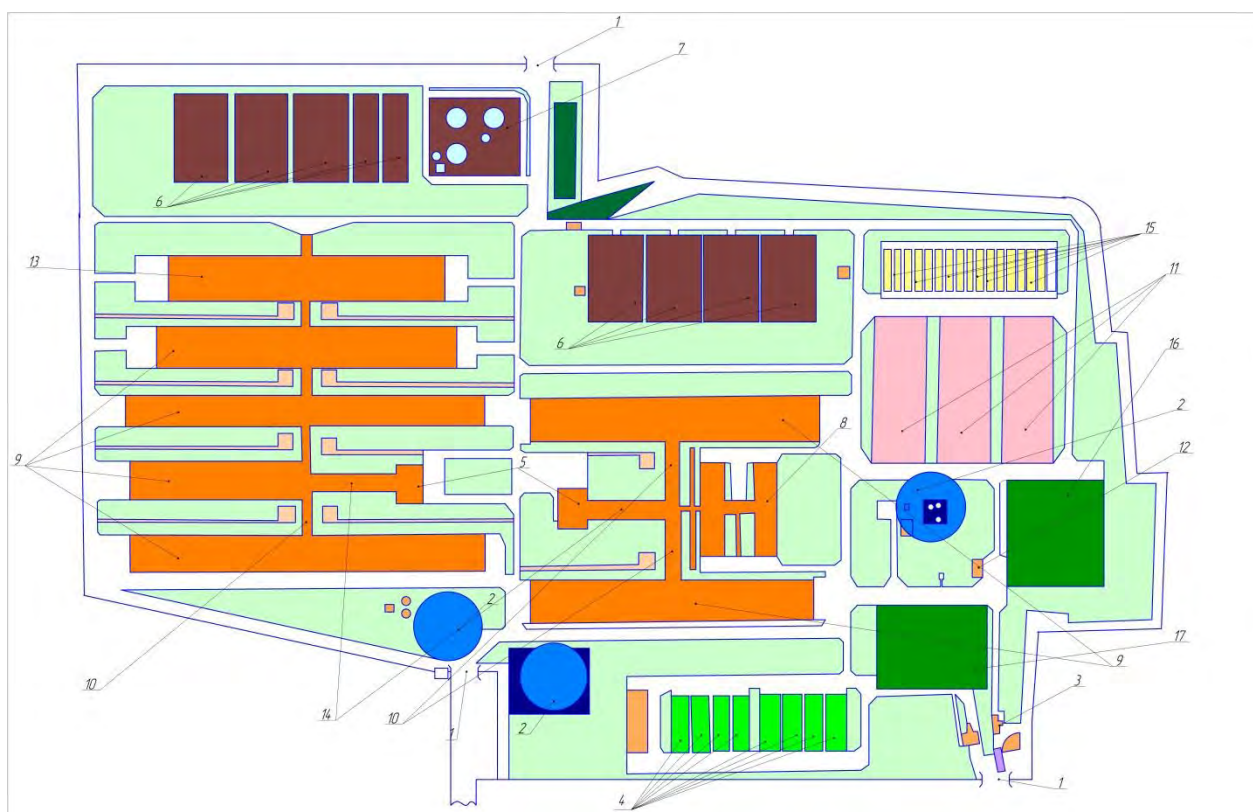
Схема генерального плану тваринницької ферми із дворядним розміщенням основних приміщень:
